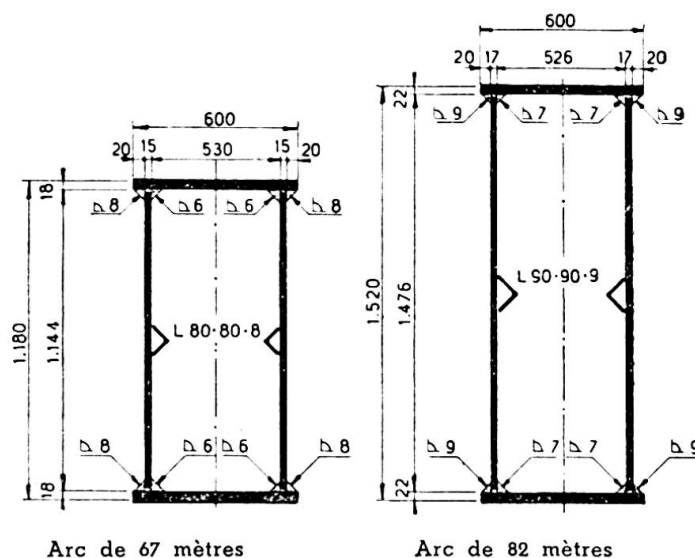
Sections en caisson des arcs du pont de Neuilly.
